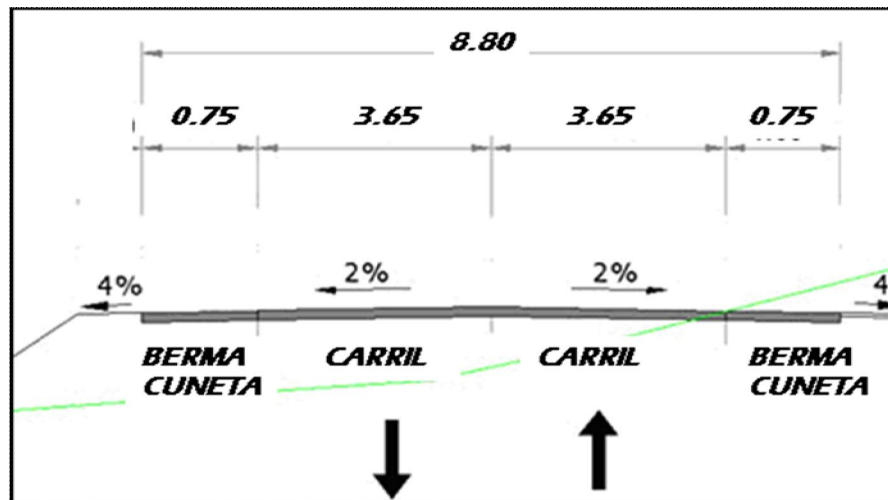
Sección Típica Construcción Calzada Sencilla.
